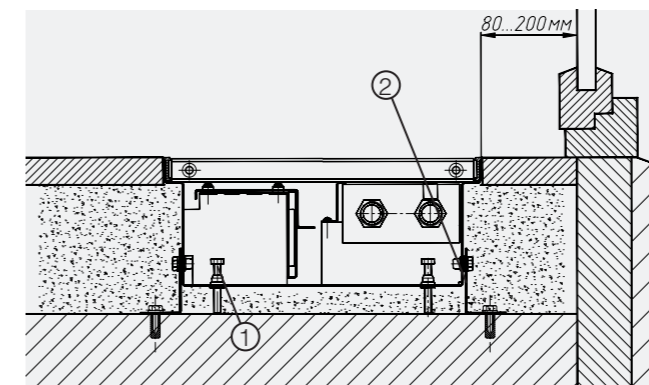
Монтаж внутрипольного конвектора: 1 – упорные болты; 2 – опоры для крепления к полу
